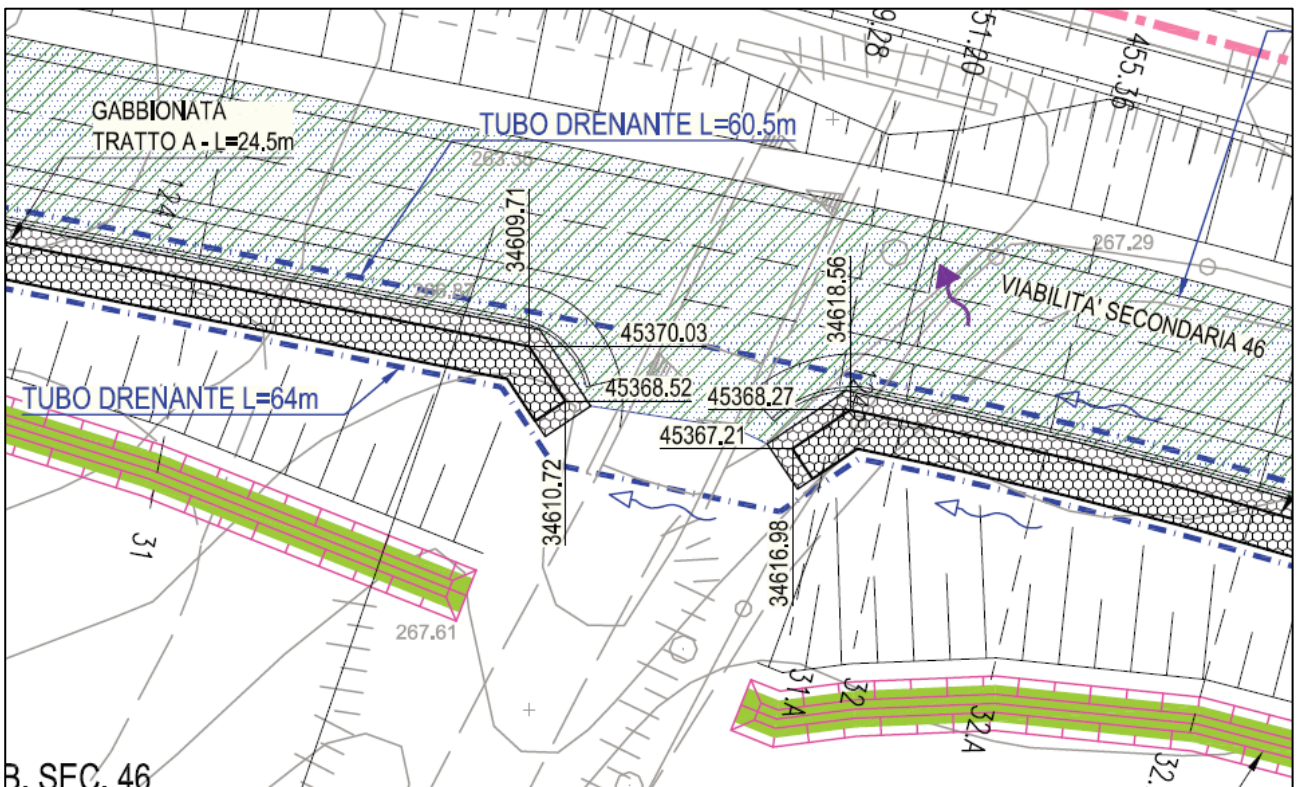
Stralcio planimetria OS113B - codifica PVOS113BN001_51_4137.
